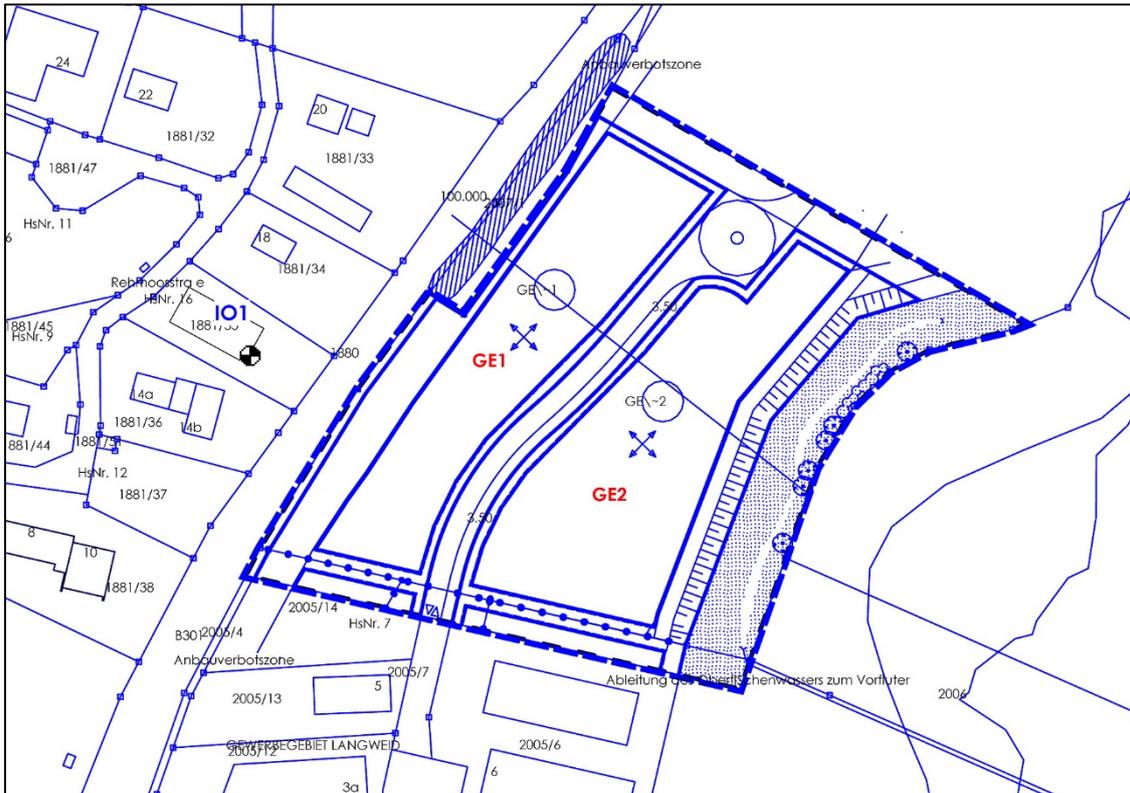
Lageplan mit Darstellung des maßgeblichen Immissionsortes (IO)
